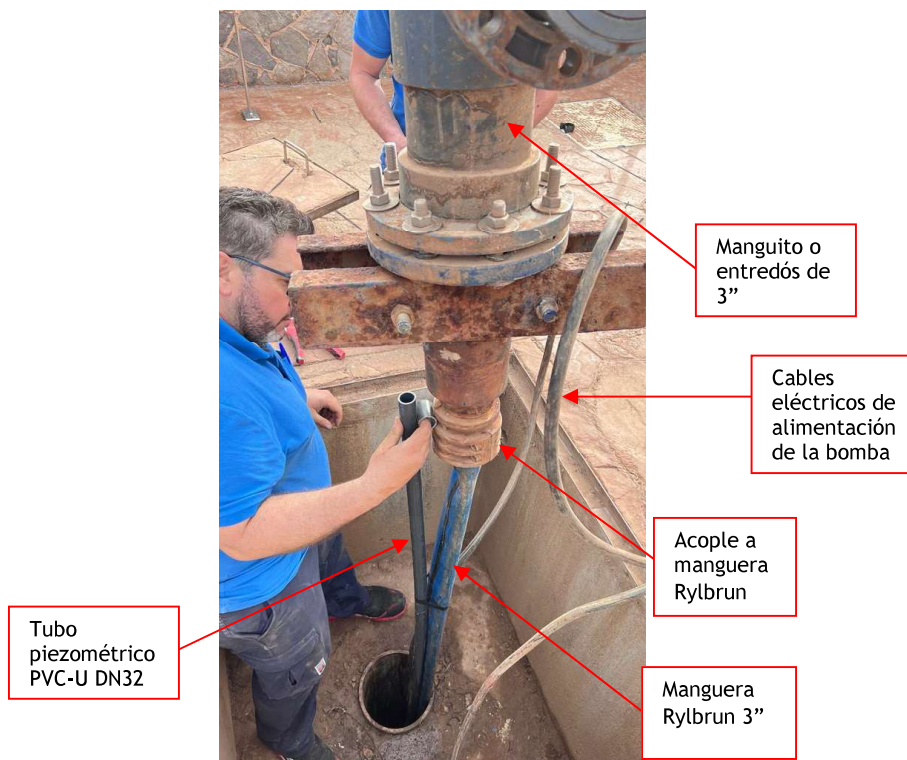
Detalle de la instalación empleada para la prueba de aforo
